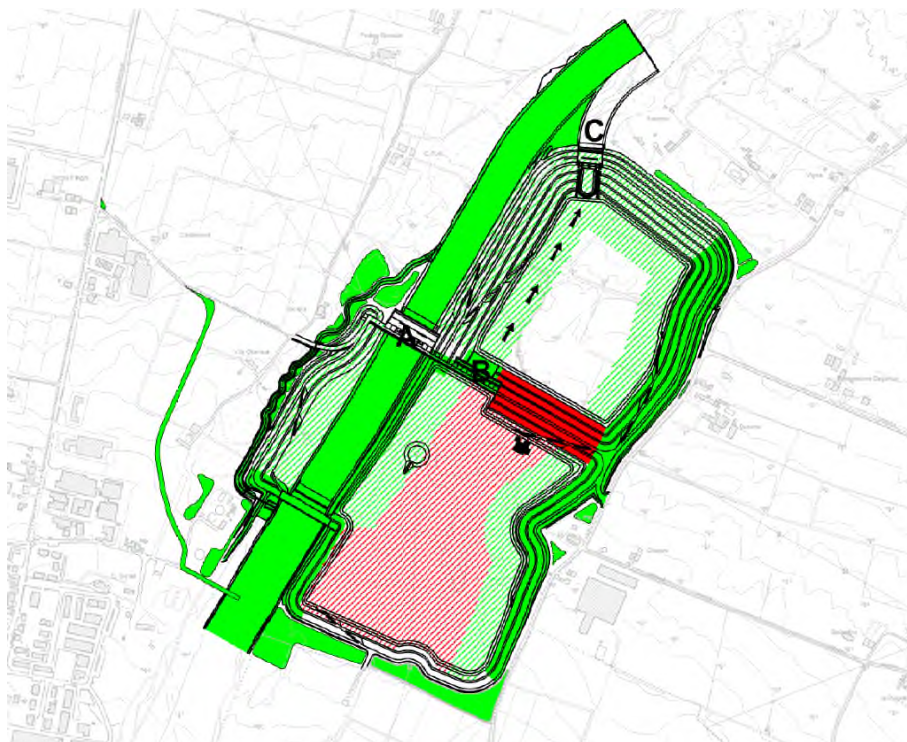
Rappresentazione planimetrica della FASE 6
